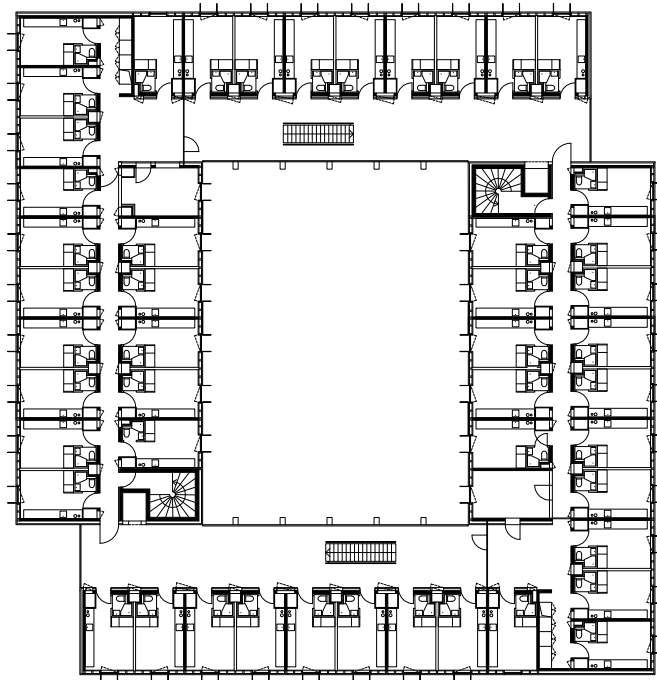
Grundriss Regelgeschoss, M. 1:500 [© BF Vario]
